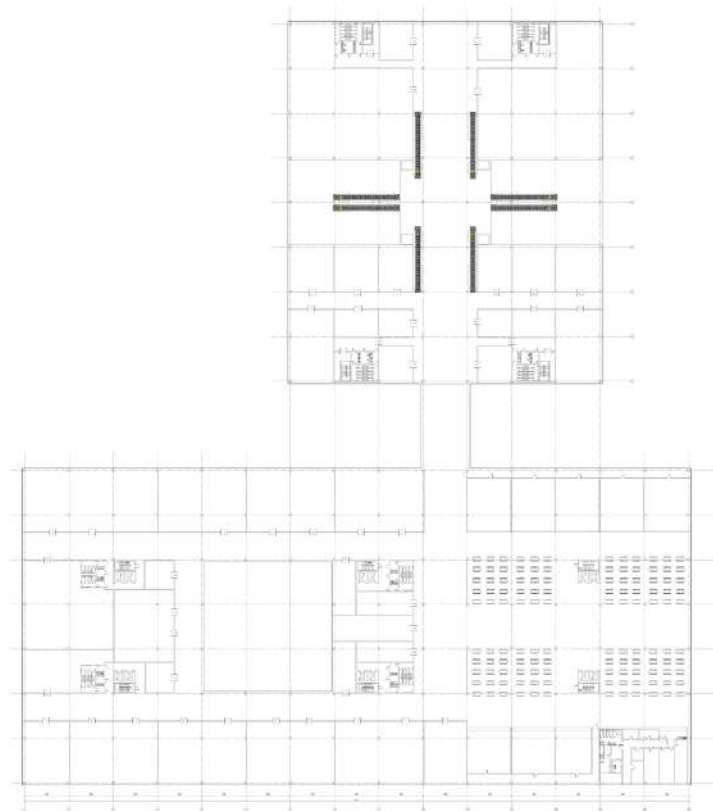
План 3-го поверху проектованої будівлі ТПВ.
